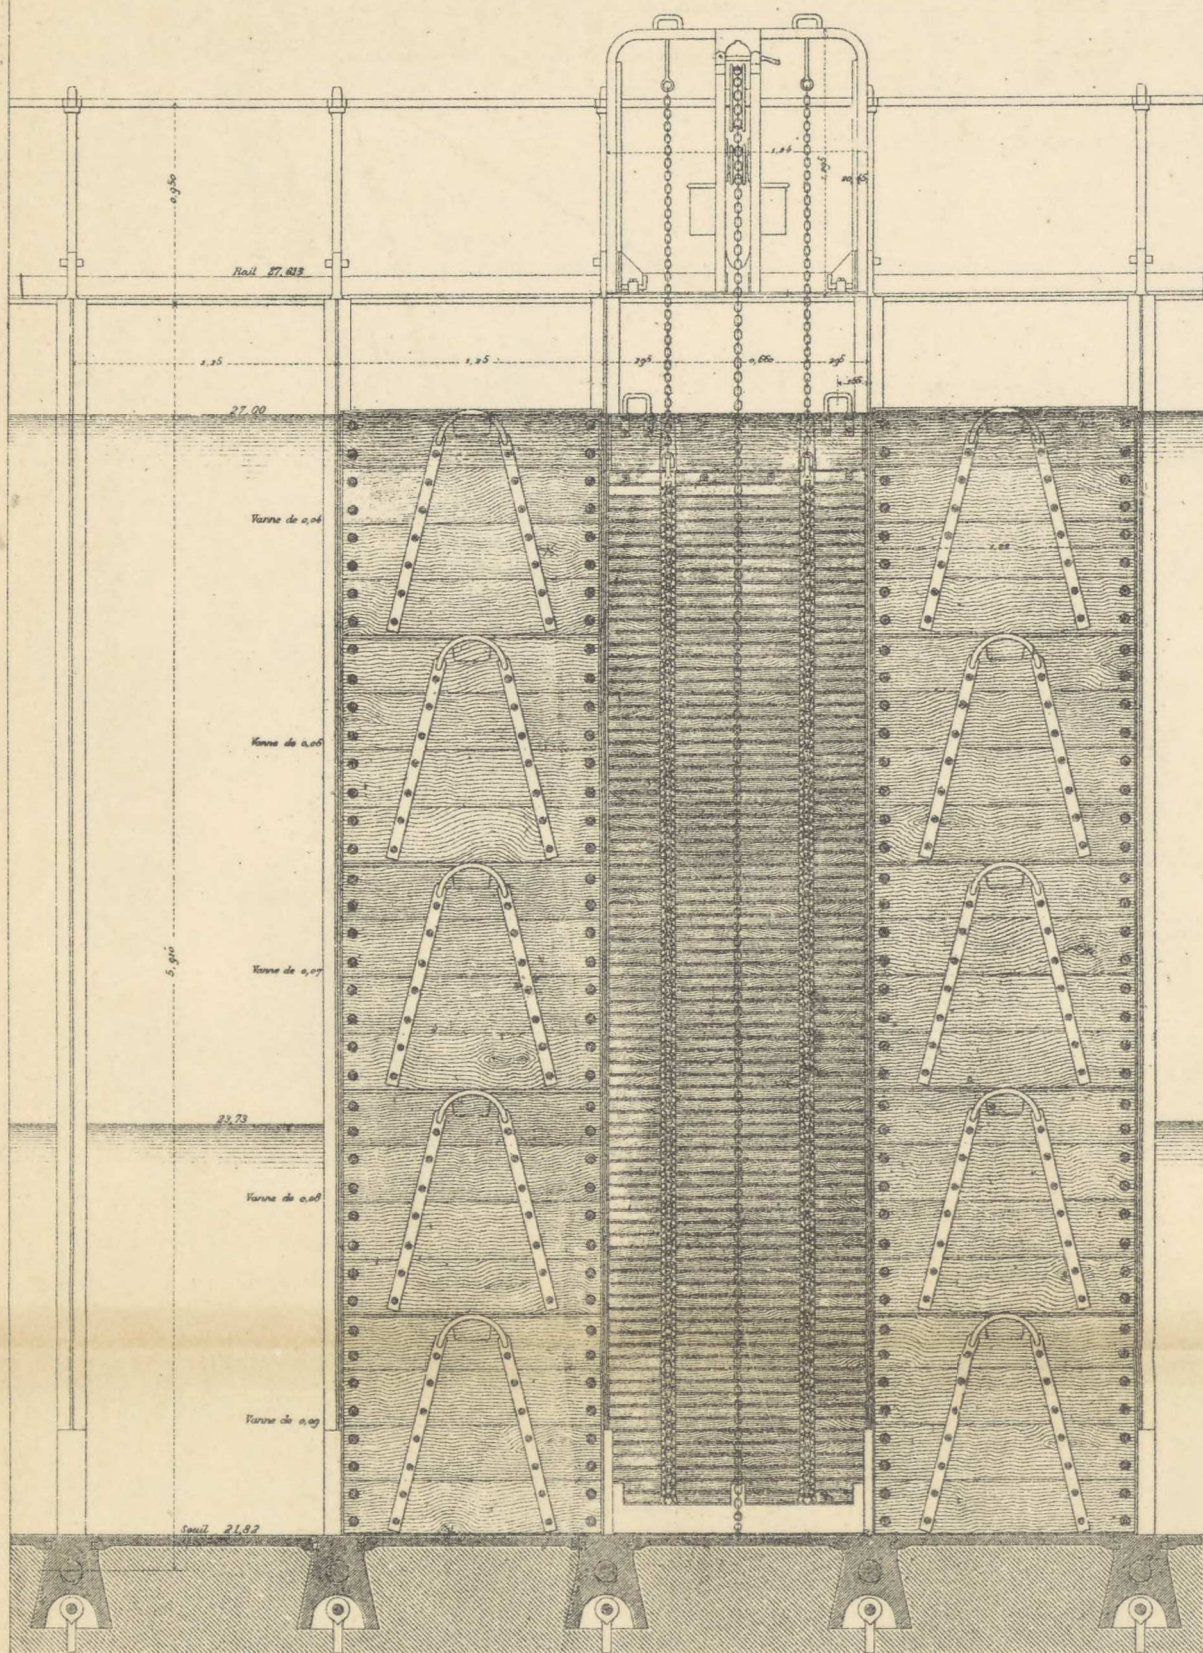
Coupe transversale du barrage et elevation d'une fermette
